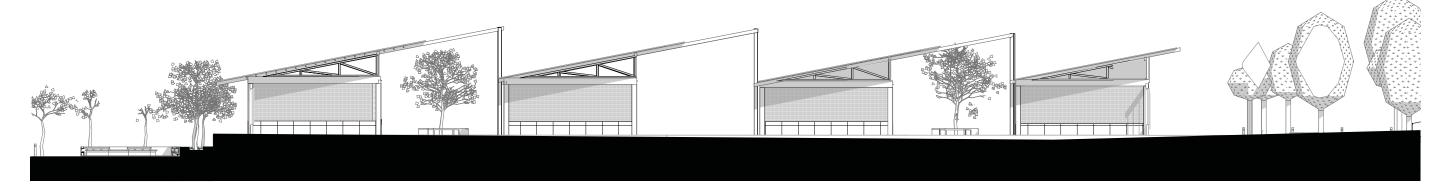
Fachada Posterior Área Aulas Fuente: Elaboración propia 2023.
